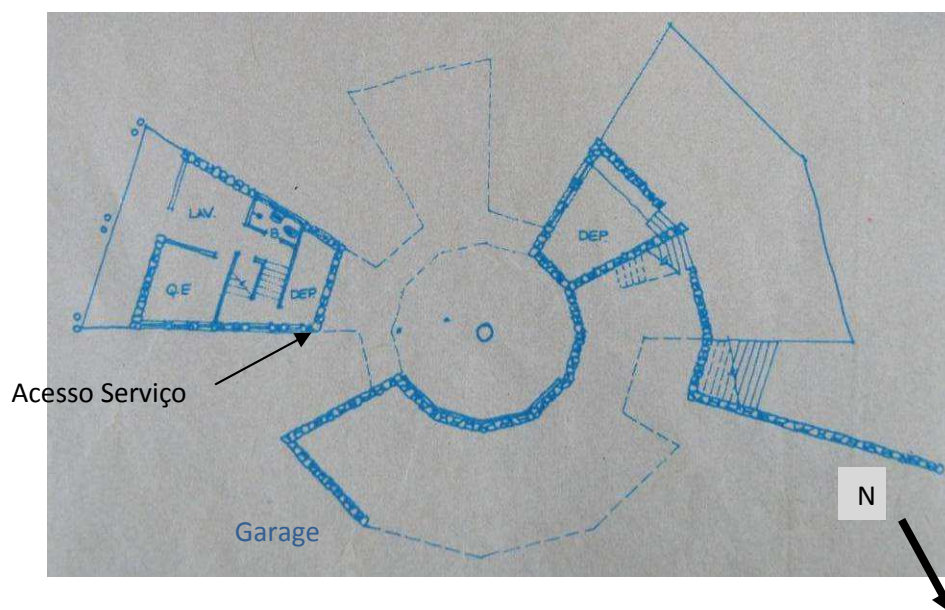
Residência Oswaldo Navarro Alves*: planta do pavimento inferior.
